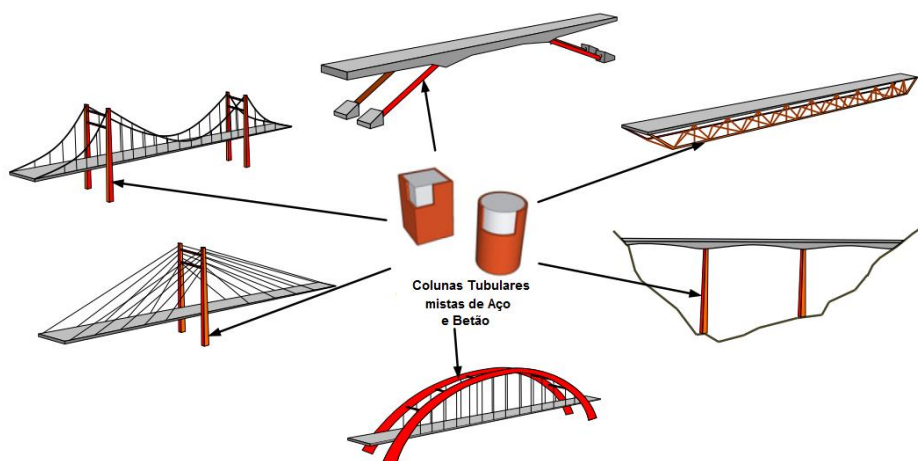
Colunas tubulares mistas de aço e betão em pontes (Han et al. 2014)
